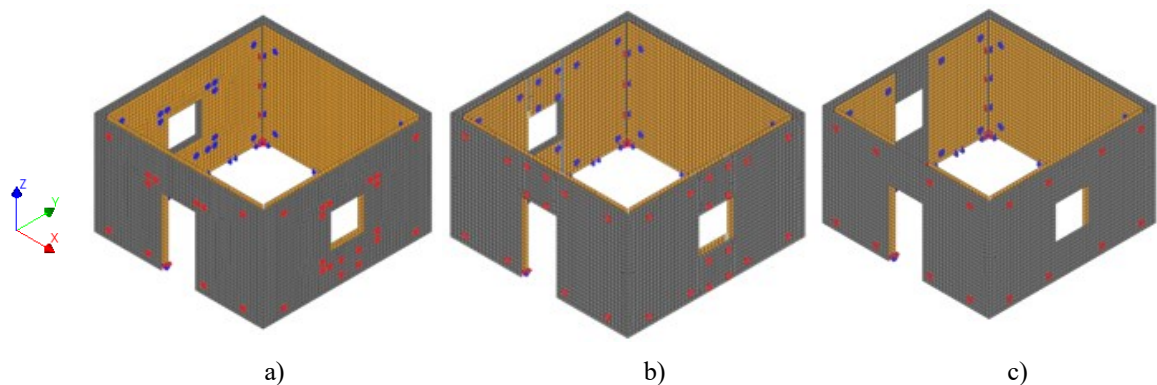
Schema planimetrico della disposizione dei dispositivi di fissaggio (elaborato ottenuto mediante *export* da *TimberTech Buildings*).
